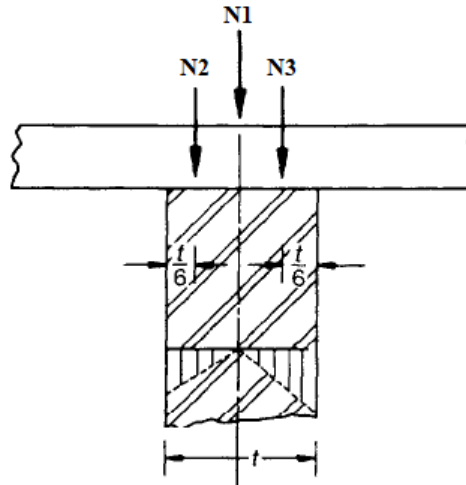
Excentricidade no topo da parede de pavimento contínuo (Adaptado de HENDRY, *et al*, p. 103).
